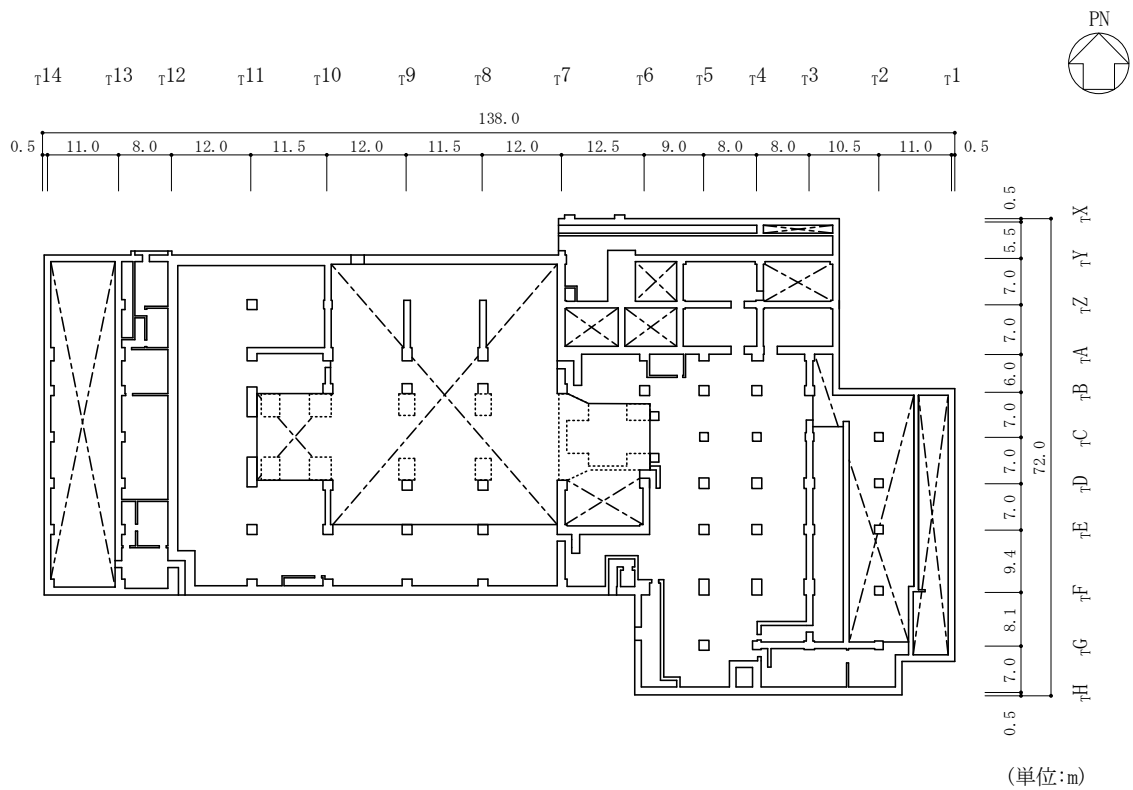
(2) タービン建物の概略平面図 (EL 5.5m)
